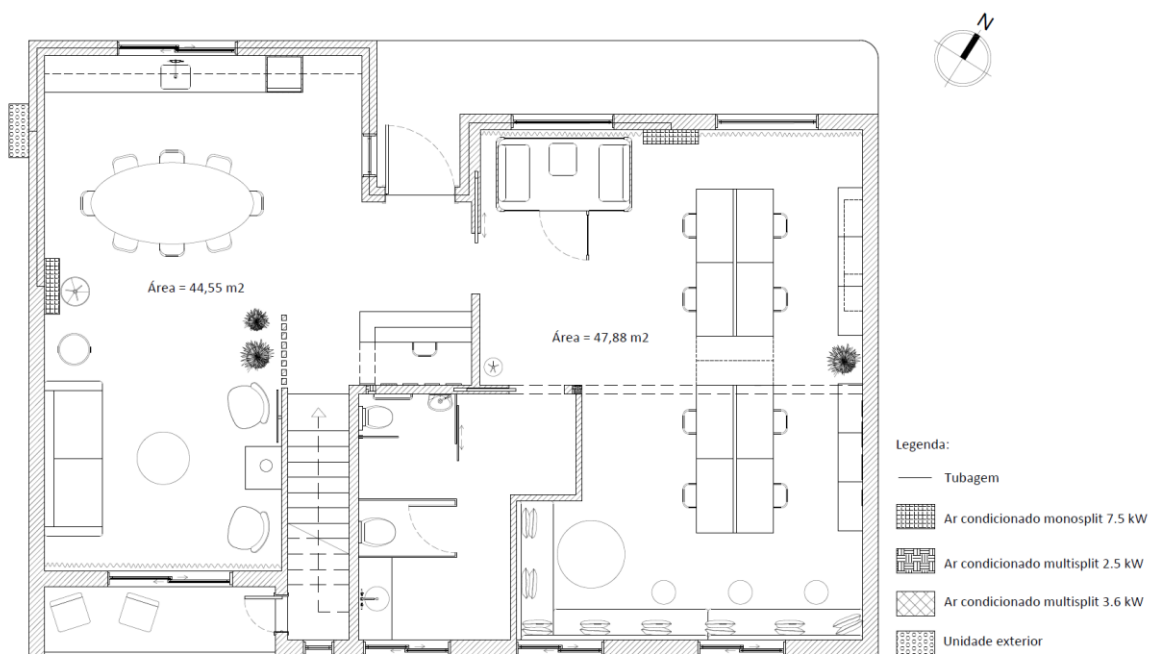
Planta de ar condicionado piso 1. Fonte: Marisa Francisco.
